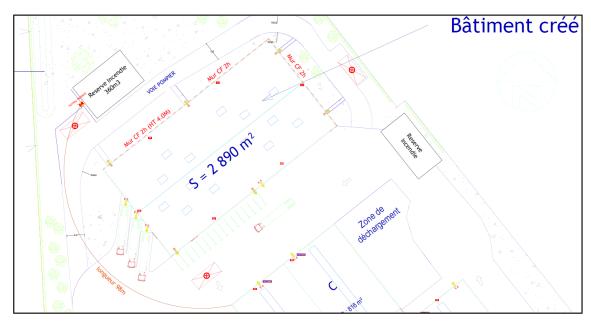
Localisation des murs coupe-feu futur bâtiment (source : sicabconstruction)
